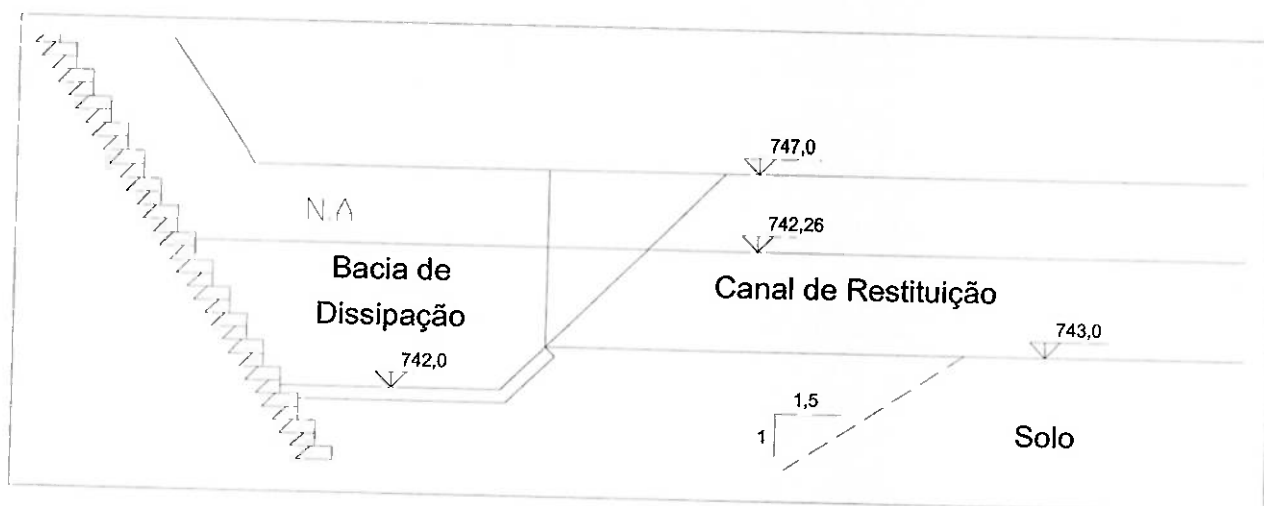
Corte BB - Colchão para amortecimento de água proveniente do vertedor
